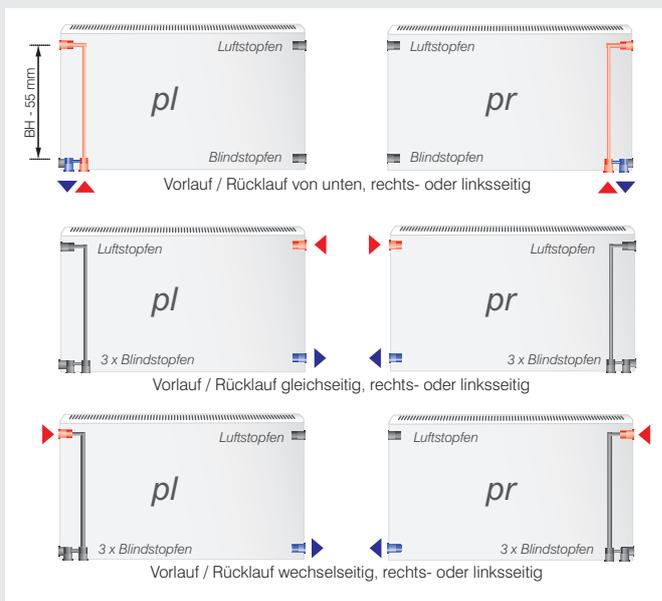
Anschlussvarianten Wärmepumpenheizkörper PLAN
